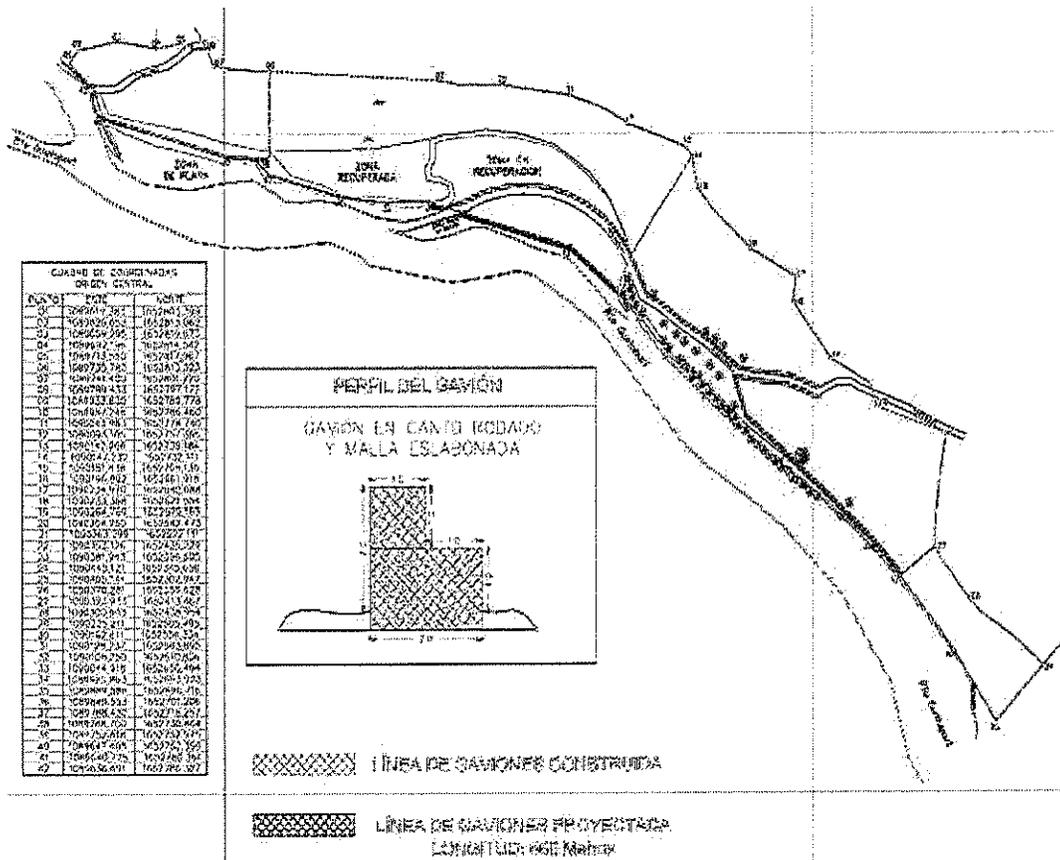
Planta del tramo proyectado de muros gaviones en el Río Guatapurí y la Acequia La Canoa.
